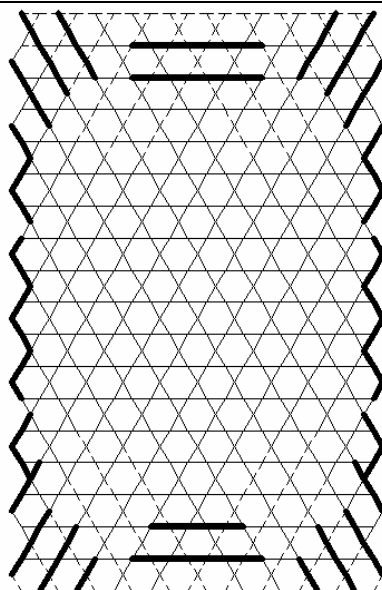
Схема размещения типов сечений стержней в структурном покрытии (план покрытия)
